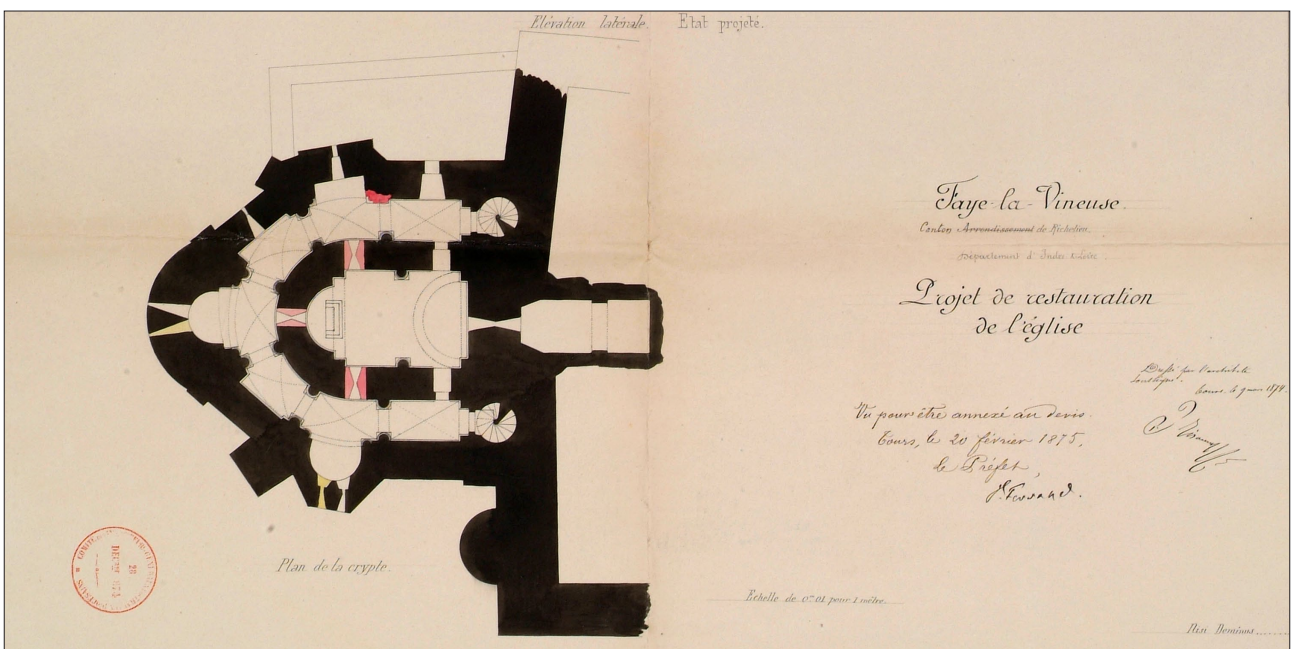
Projet de restauration de l'église de 1874 – AD37 20105_002 – Détail, plan de la crypte
